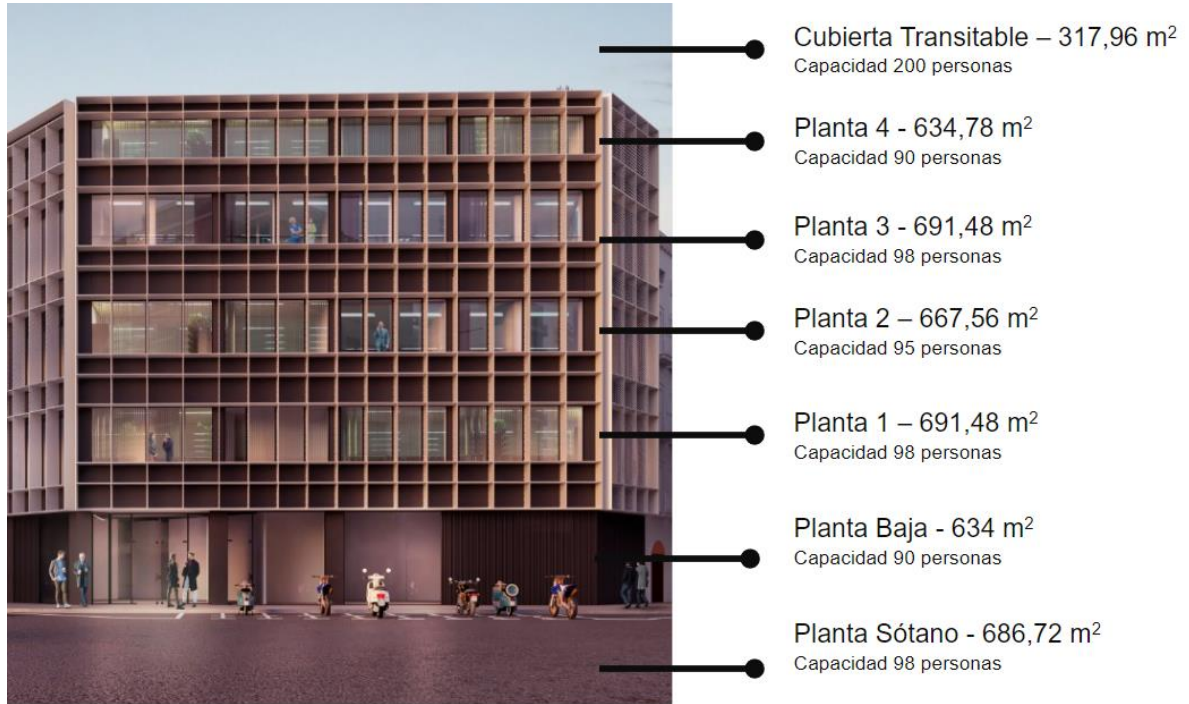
Distribución de metros cuadrados por planta en el proyecto de AVILA60 (fuente: Ponder Trade, 2023).
